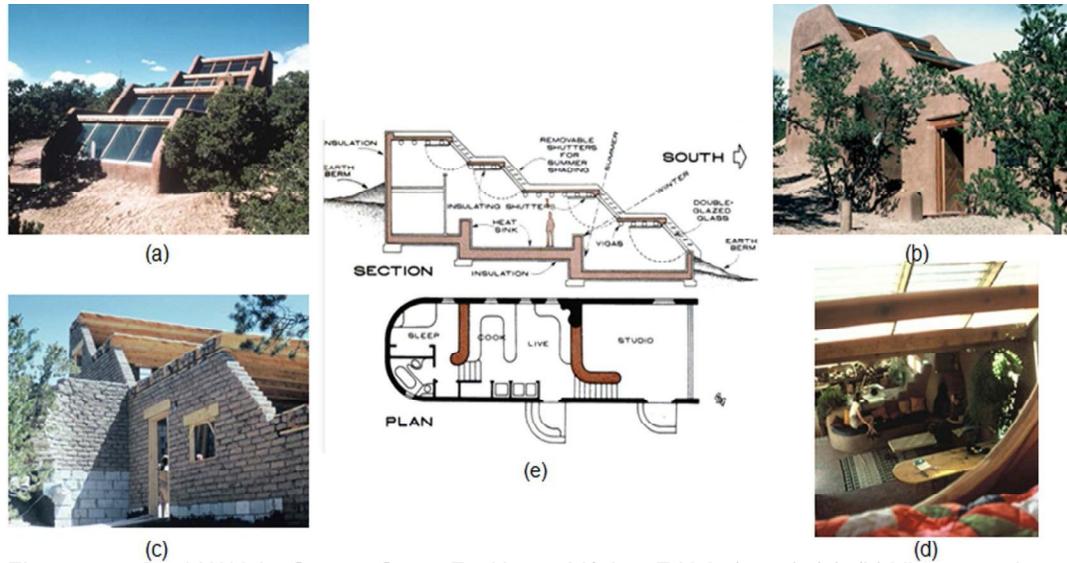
David Wright, Sustep, Santa Fe, Nuevo México, E.U.A, (1976): (a), (b) Vistas exteriores, (c) Vista exterior durante la fase de construcción, (d) Detalle interior, (e) Sección longitudinal y planta arquitectónica.
